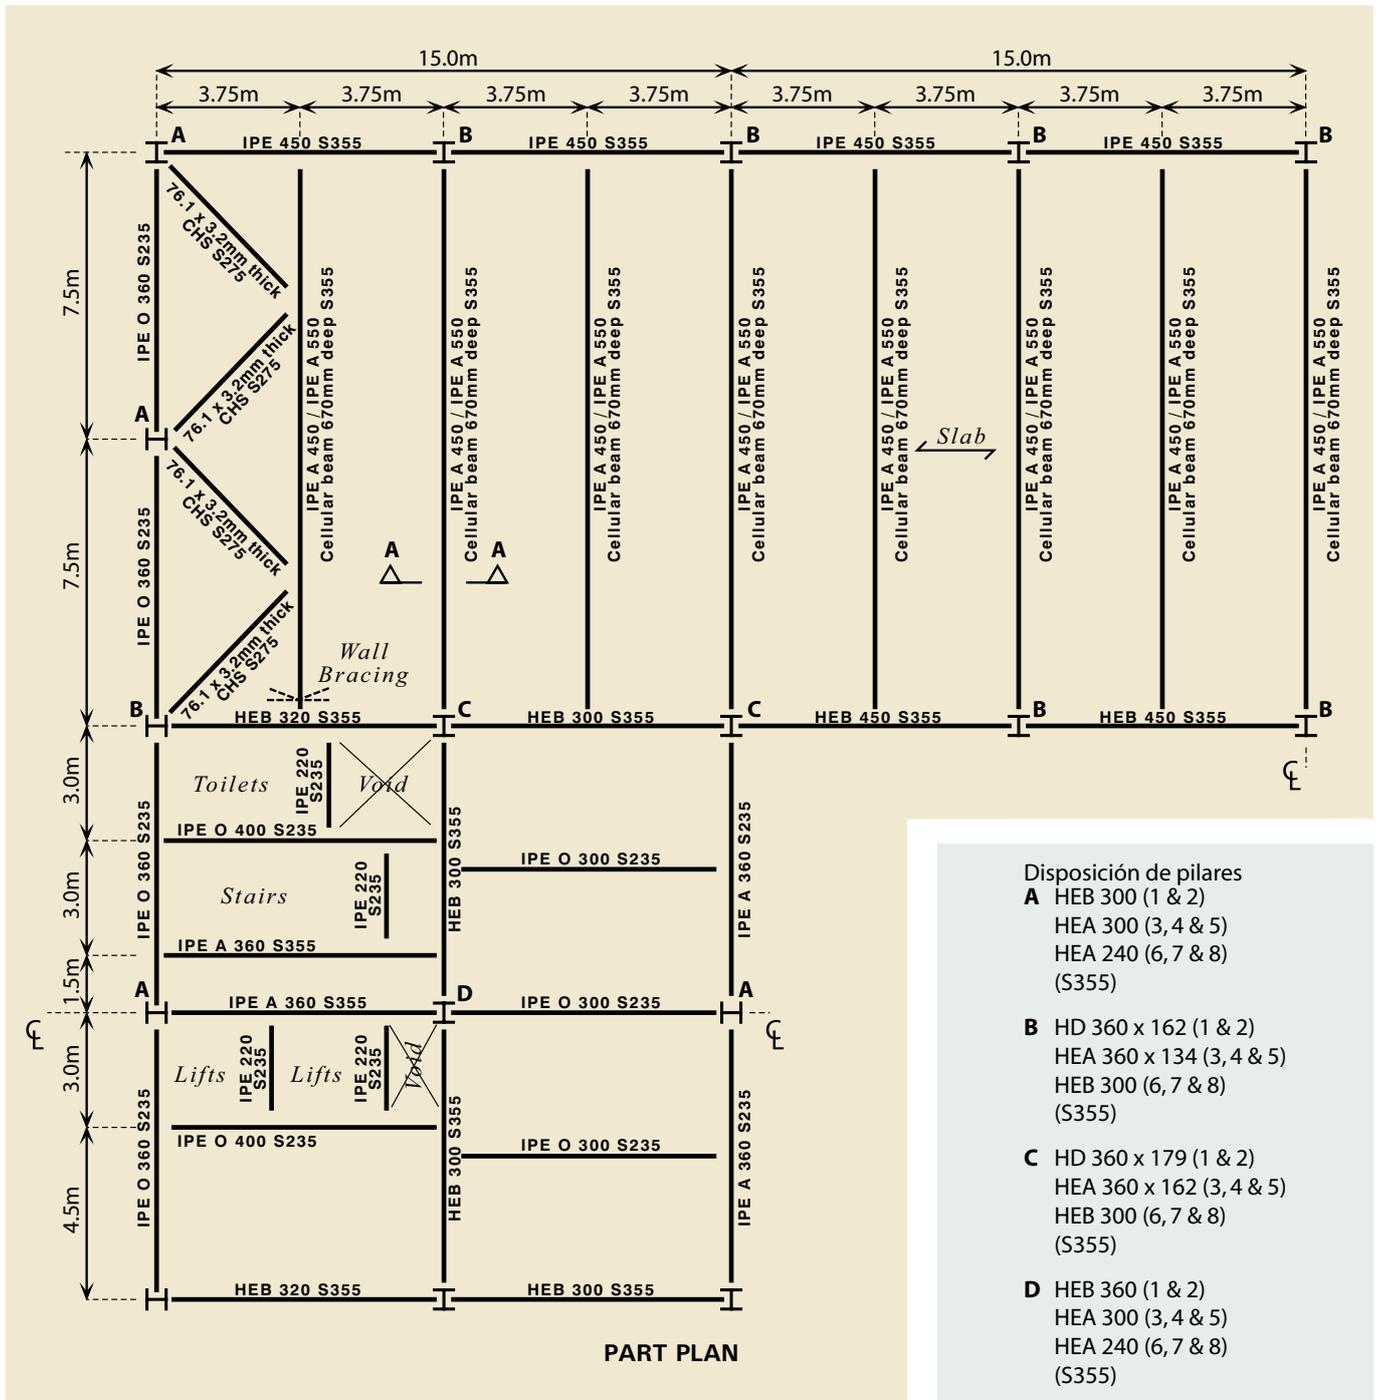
Vigas alveolares (vigas secundarias con grandes luces) y forjados mixtos. Disposición en planta de la estructura de un edificio de 8 plantas con distribución rectangular
